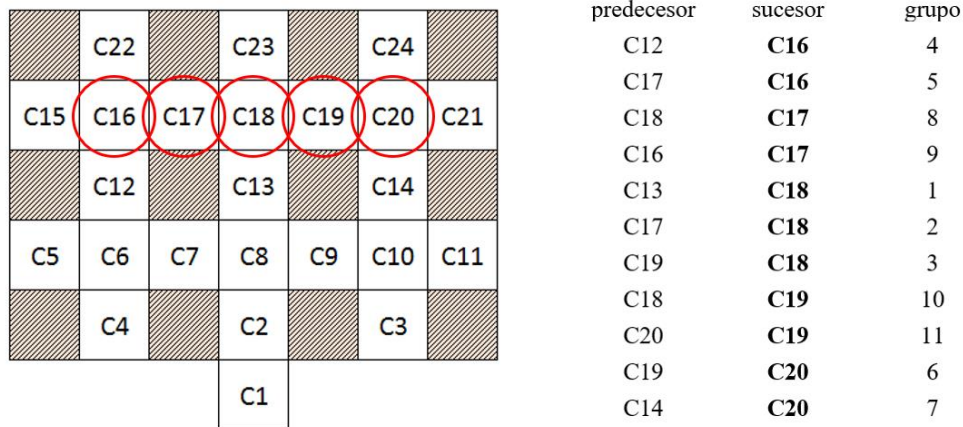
Vista en planta del nivel Room & Pillar y precedencias tipo “o”, caso de prueba.
